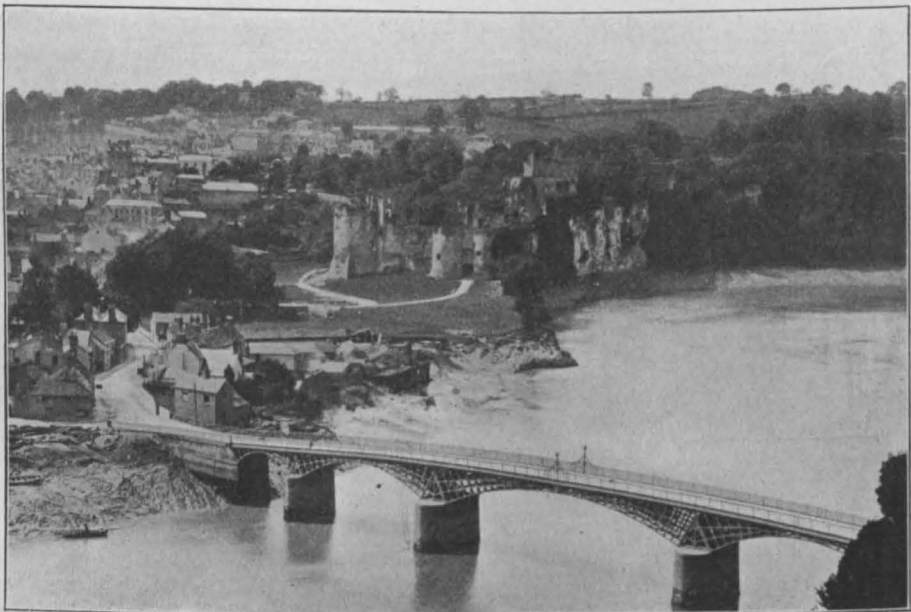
Brücke über den Wye in Chepstow. 1816.
